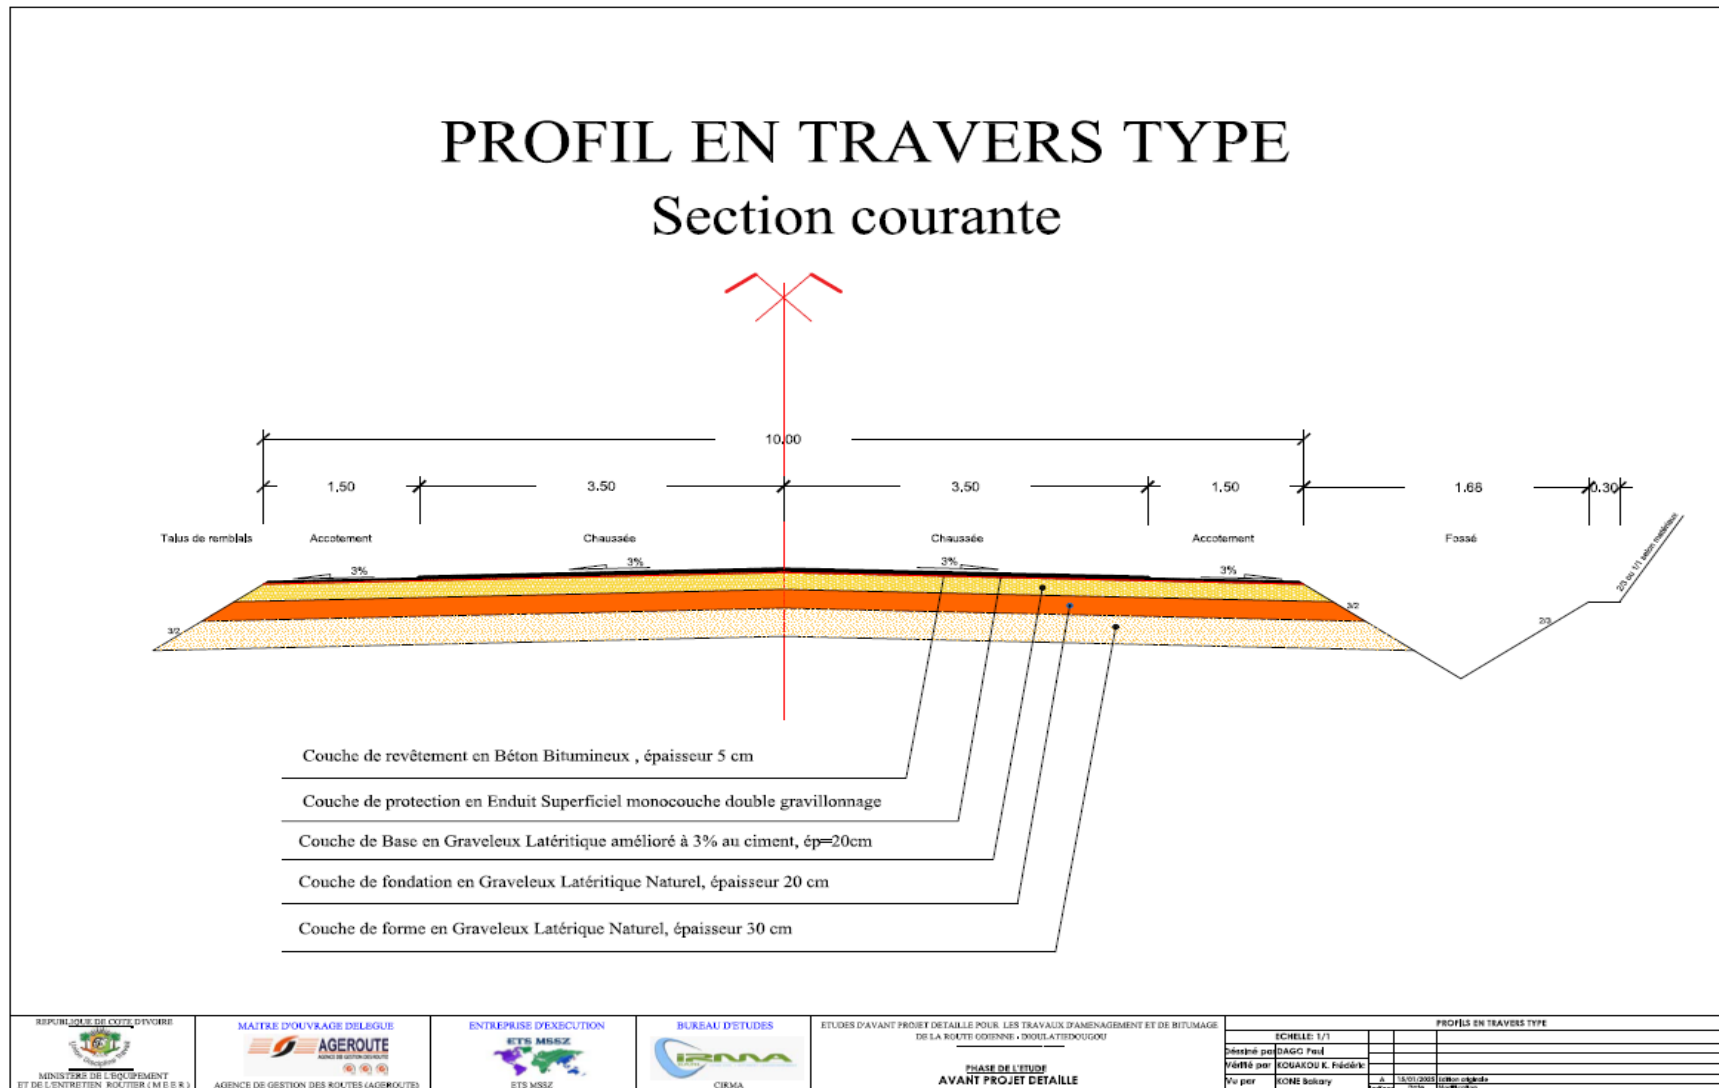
Profil en travers type de la section courante de la route à bitumer
